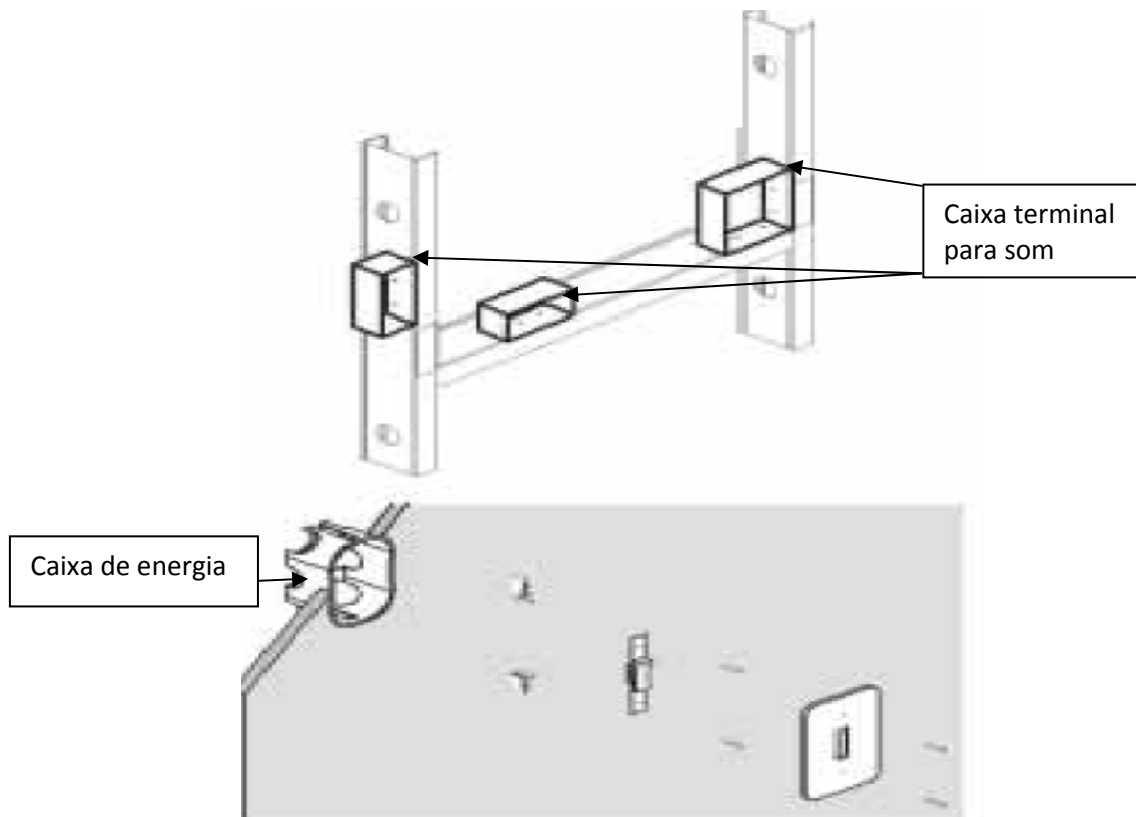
Caixas terminais para rede elétrica (Associação Brasileira do Drywall, 2016)
